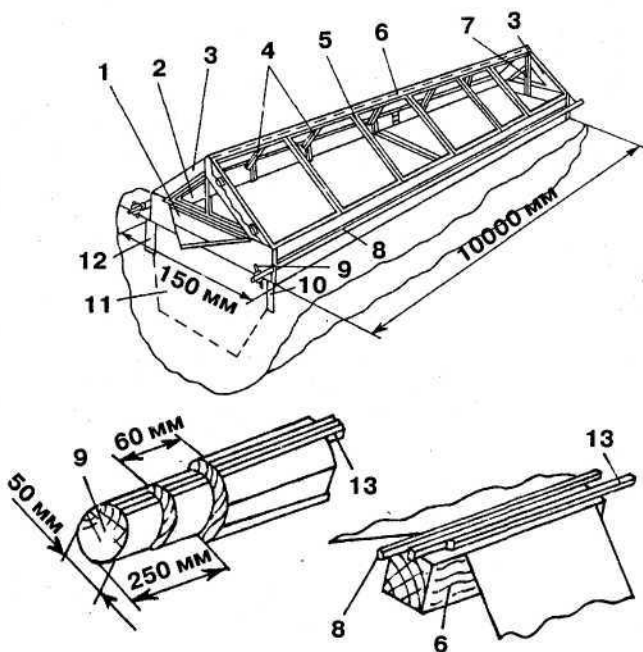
Цельнодеревянный каркас под пленку: 1 — крышка люка; 2 — вентиляционный люк; 3 — торцы каркаса; 4 — бортовые стойки; 5 — несущие планки; 6 — стропильный коньковый брус; 7 — бортовая и коньковая стойка; 8 — бобина; 9 — вороток; 10 — правый парубень; 11 — котлован парника; 12 — левый парубень; 13 — рейки-штапики
